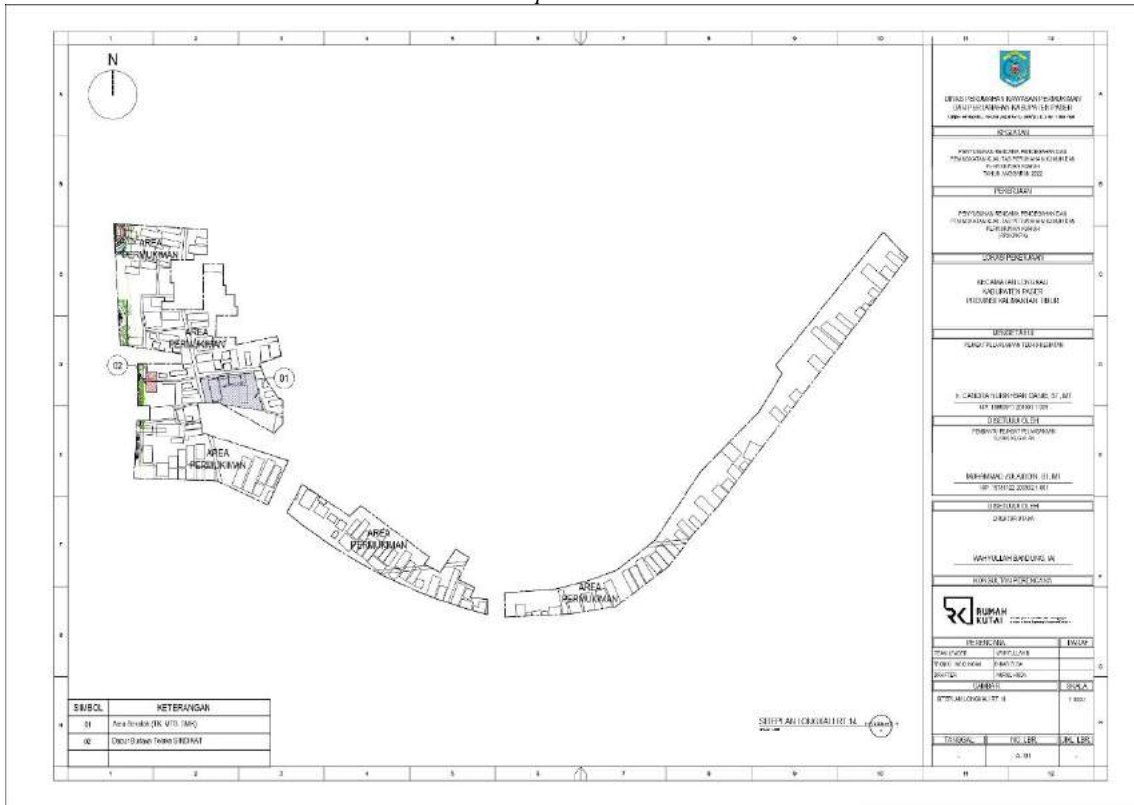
73 Konsep Rencana Pelebaran dan Perbaikan Jalan RT.11
